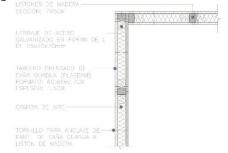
Detalle de pared con paneles prefabricados de caña guadúa + ventana
